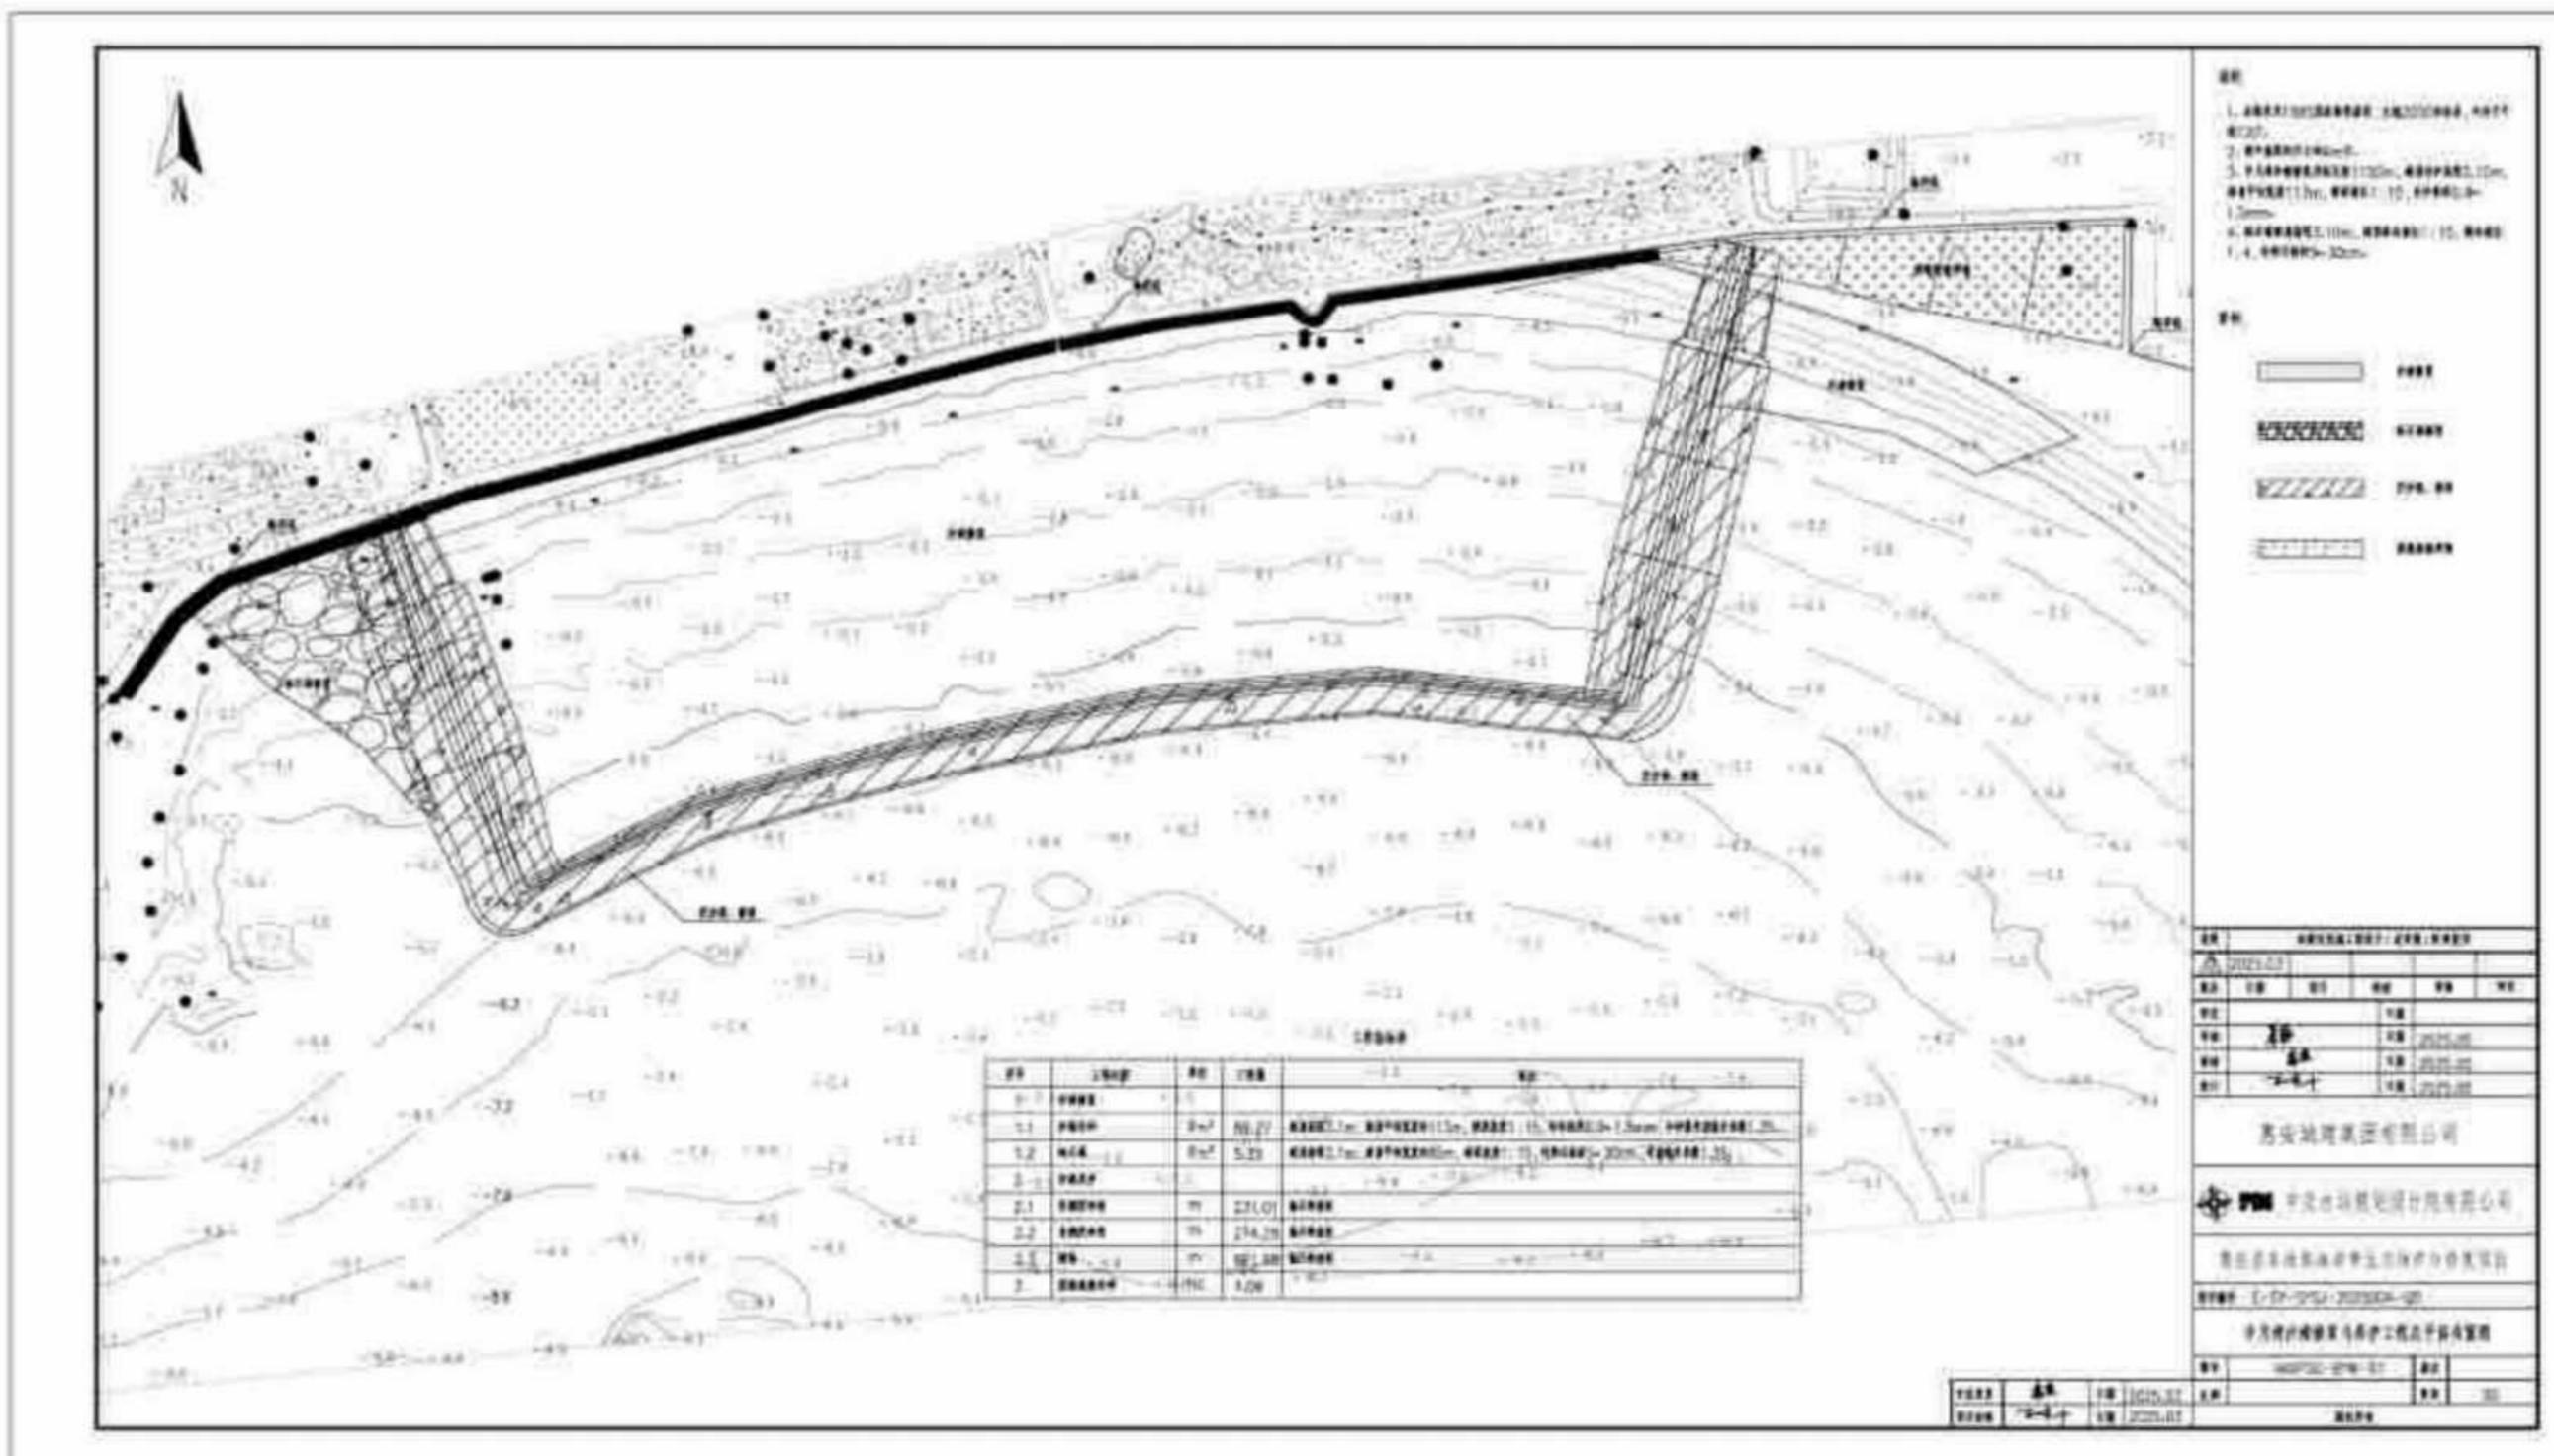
半月湾海岸带生态保护与修复工程平面布置图
